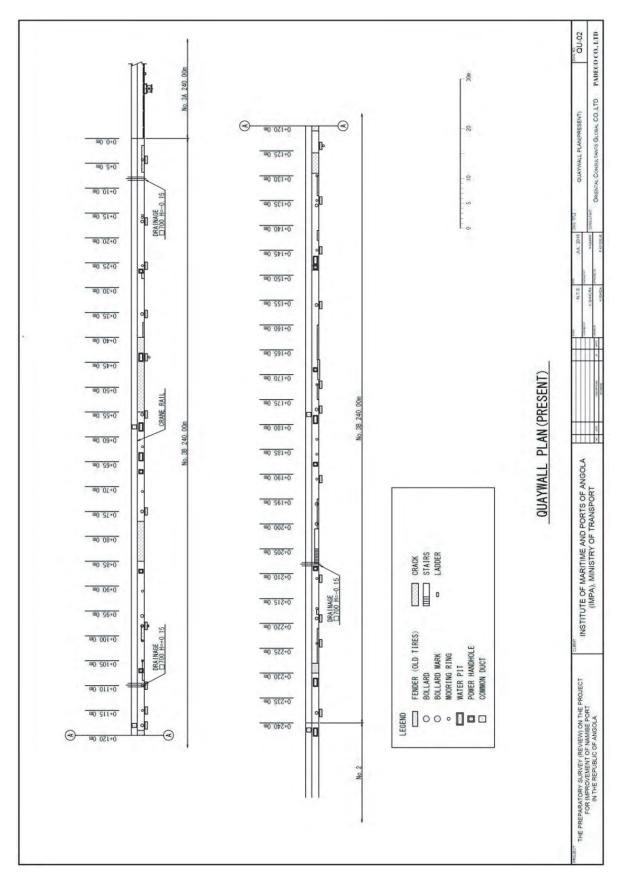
Planta Baixa Situacional do Muro da Zona 3B do Porto do Namibe
